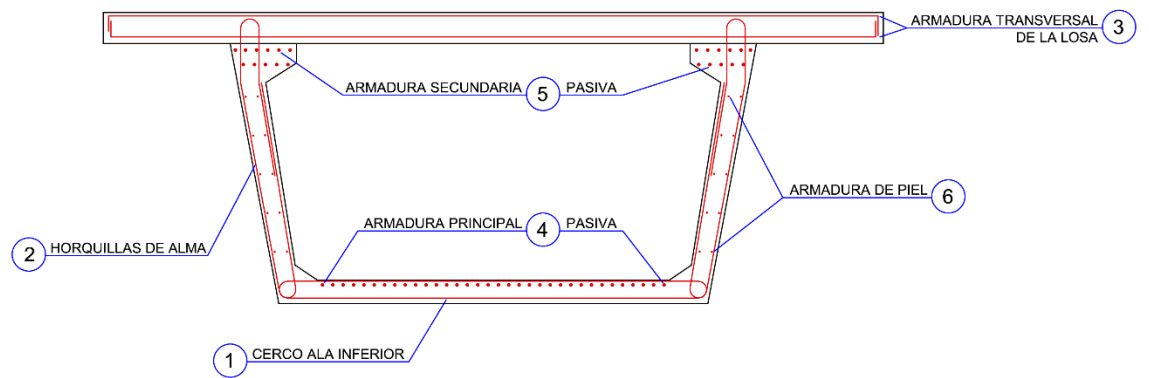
Esquema de disposición del montaje de la armadura en el vano central
